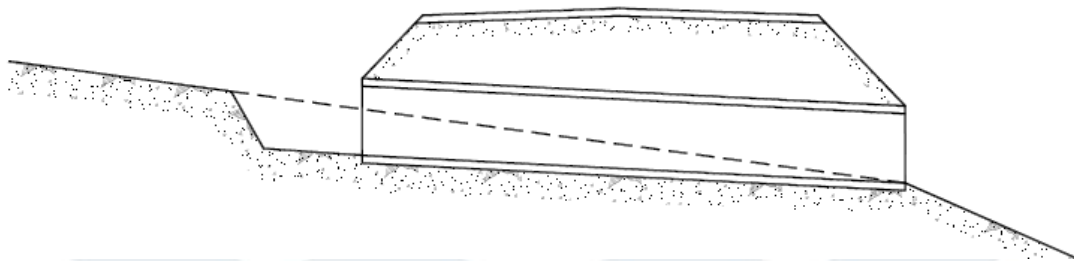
Esquema de una obra de drenaje transversal o alcantarilla en media ladera
